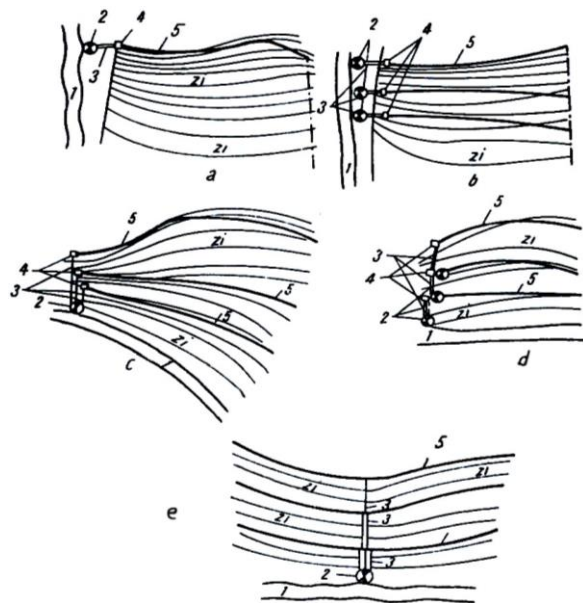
Schema amplasării canalelor principale alimentate mecanic: a – varianta I; b – varianta II; c – varianta III; d – varianta IV; e – varianta V; 1 – râu; 2 – stații de pompare și repompare; 3 – conducte de refulare; 4 – bazin; 5 – canale principale; zi – zone de irigat.
